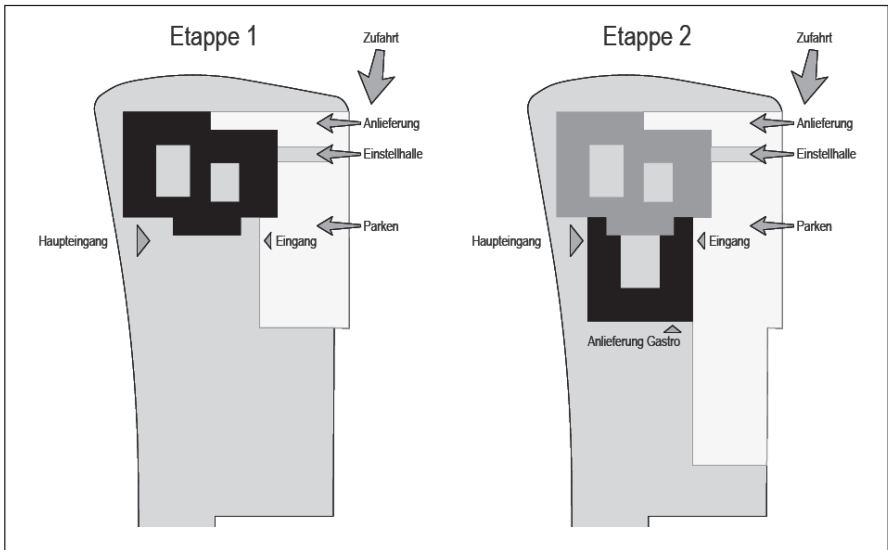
Situationsplan mit vorgeschlagener Etappierung gemäss Testplanung
